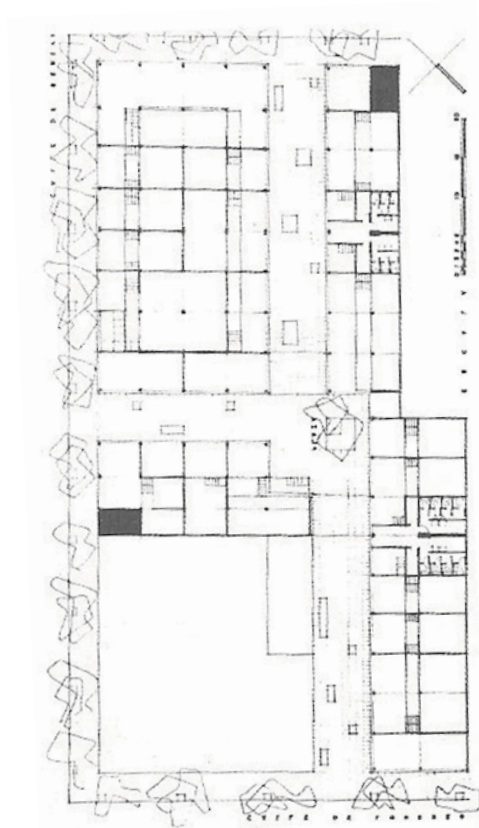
Planta Arquitectónica donde se observa la integración de los tres bloques
